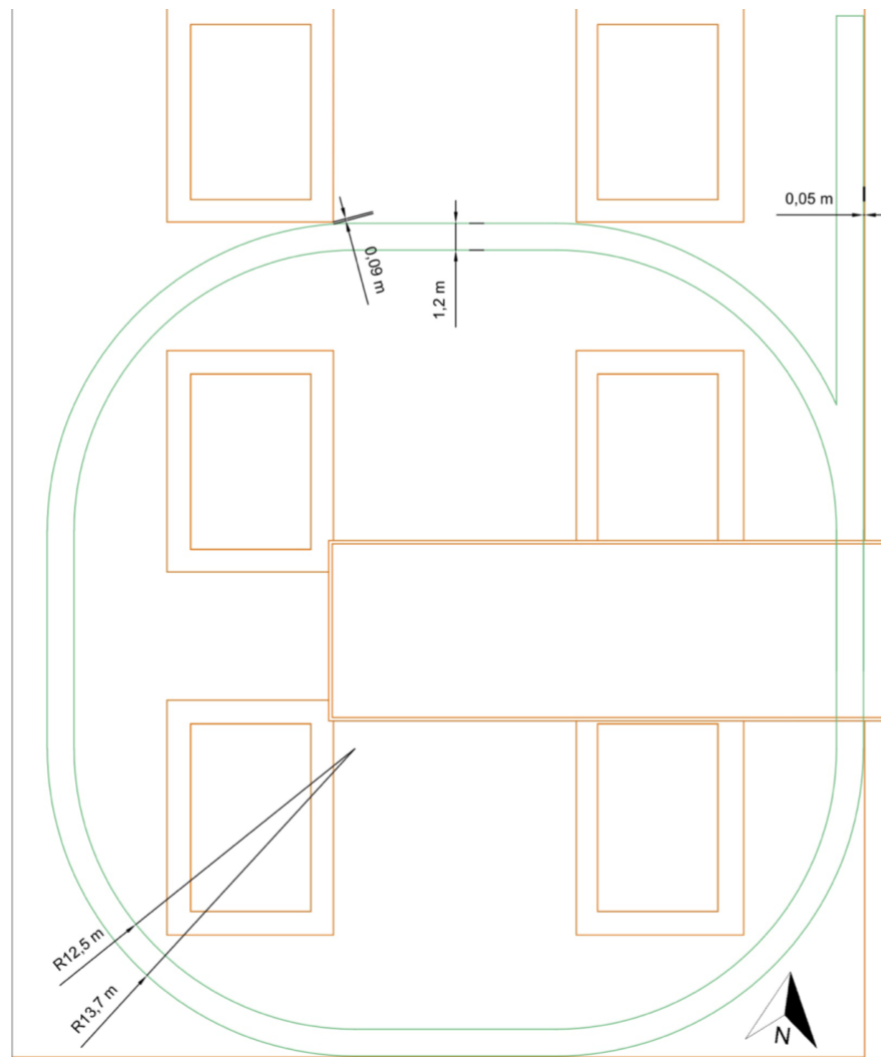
Cajón en la postura que da soporte a la vía en placa. Plano Anexo N° 8.
